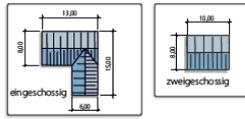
Mögliche Variante für die Gestaltung einer Baufläche nördlich der Schützenhalle
